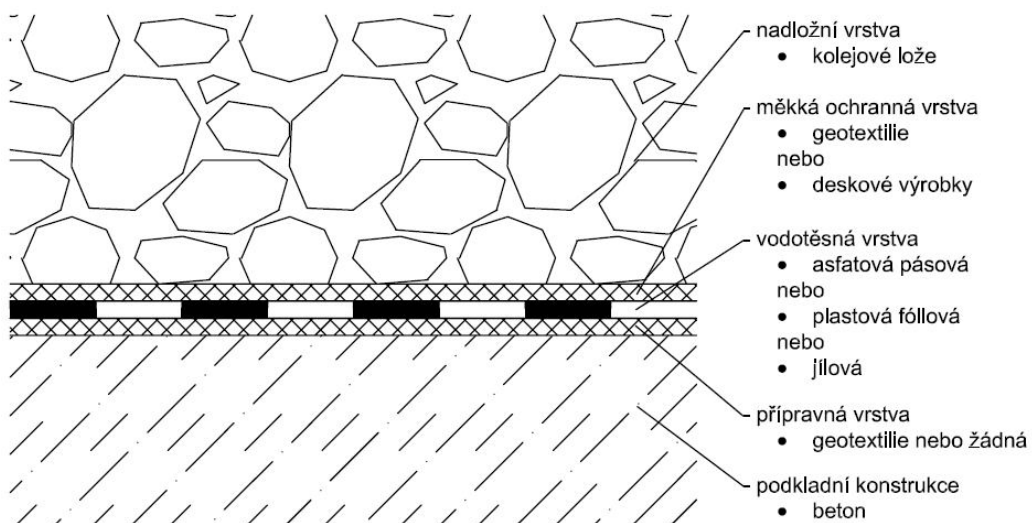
SVI pln plošně spojený s betonovou podkladní konstrukcí, měkká ochranná vrstva – geotextilie
